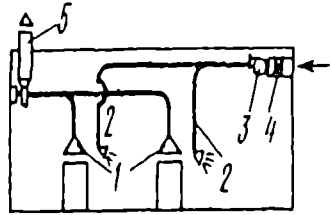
Схема местной вентиляции: 1 – вытяжные зонты над местами выделения вредностей; 2 – приточные воздушные души; 3 – вентилятор; 4 – калорифер; 5 – агрегат вытяжной вентиляции
